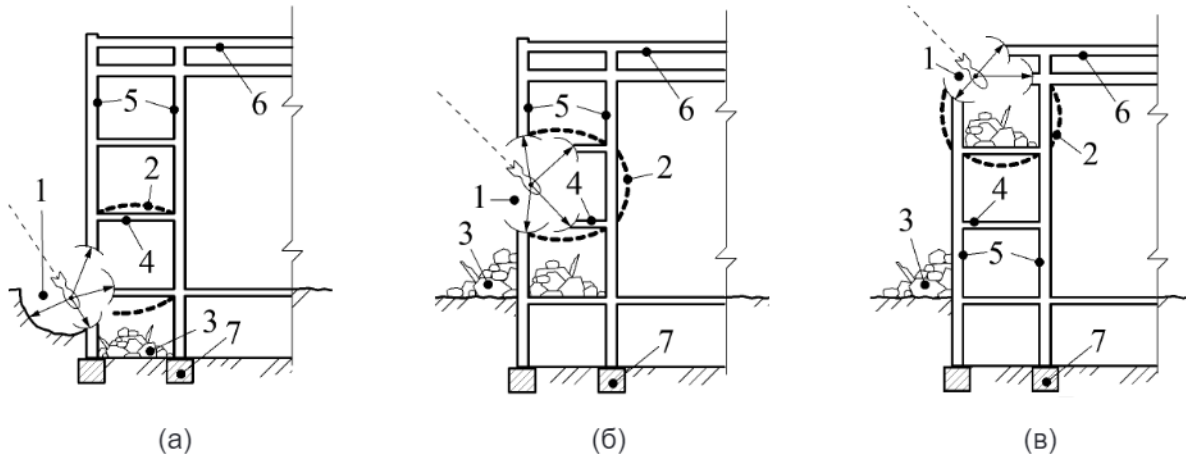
Будівля зі збірним залізобетонним каркасом, пошкоджена внаслідок позапроектних впливів у зоні першого (а), середнього (б) та верхнього (в) поверхів
